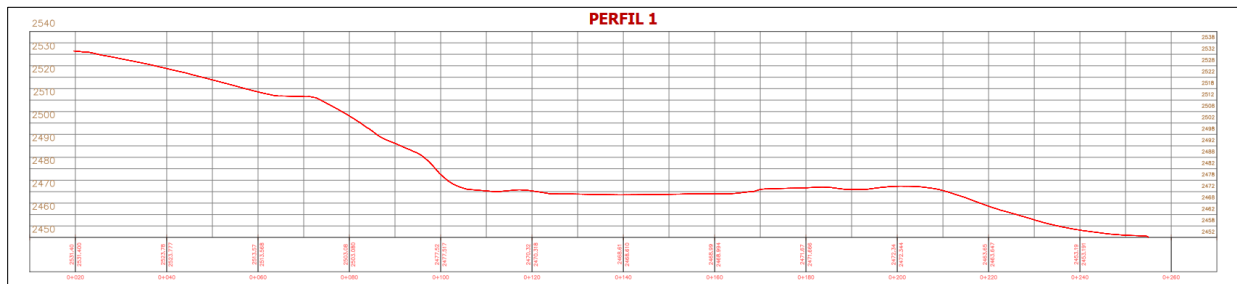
Perfil generado por Civil 3D con aerofotogrametría. Fuente: Autoría.
